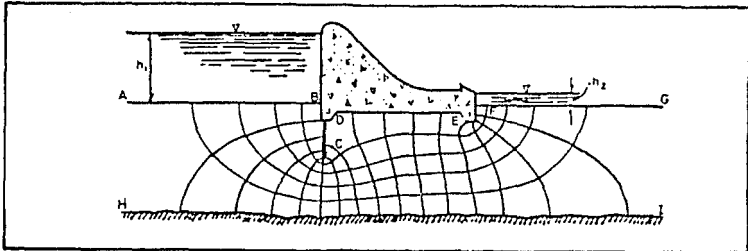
FLUJO CONFINADO BAJO LA CIMENTACIÓN DE UNA ESTRUCTURA VERTEDEDORA
